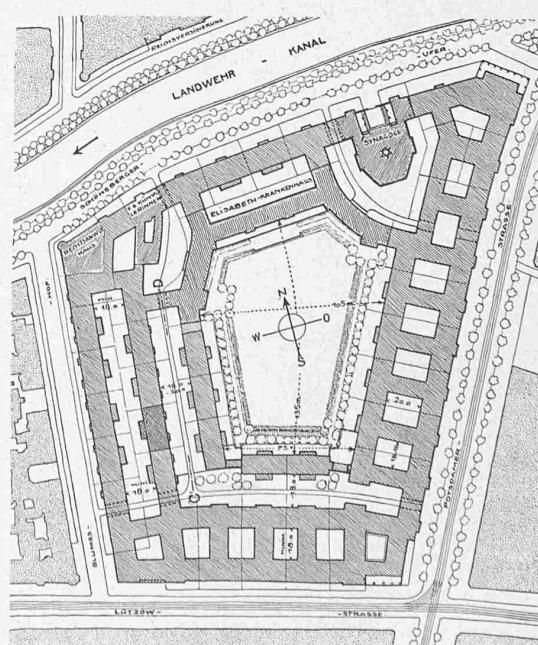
Lageplan der Variante. — Masstab 1:4000.
